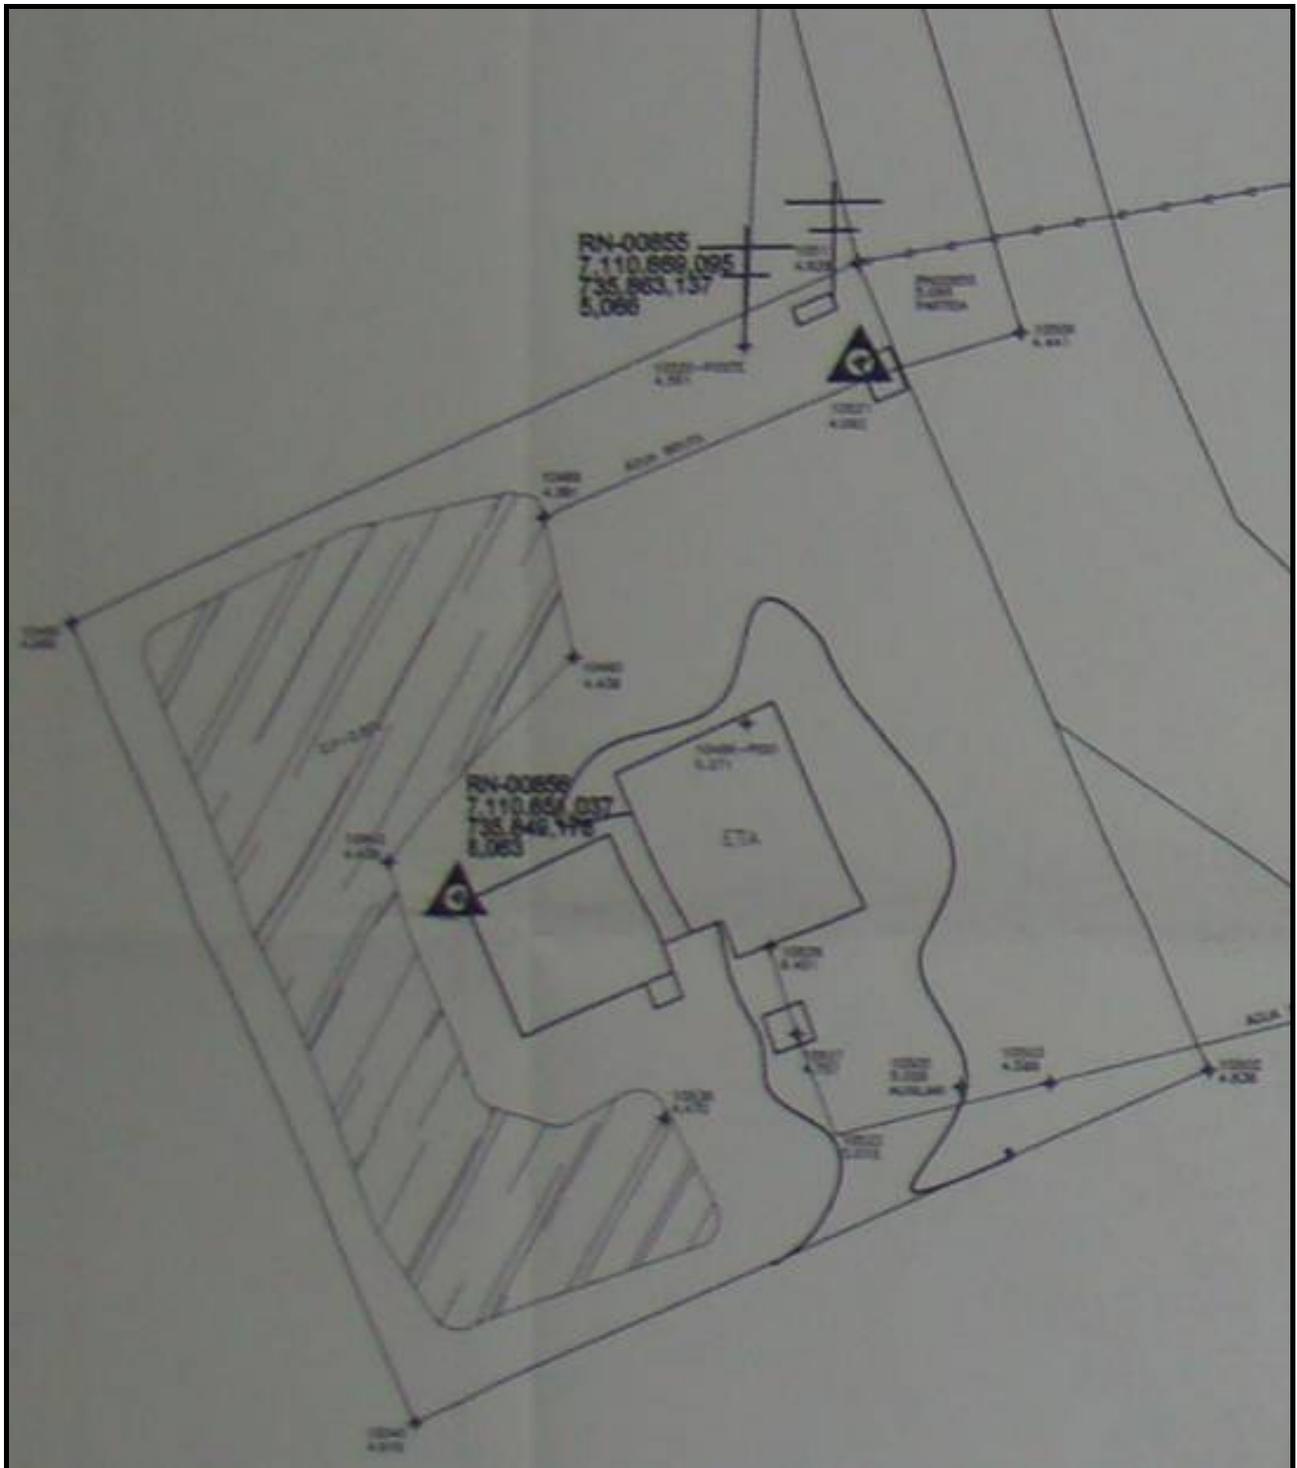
Planta Baixa – Lay-out da Estação de Tratamento de Água
